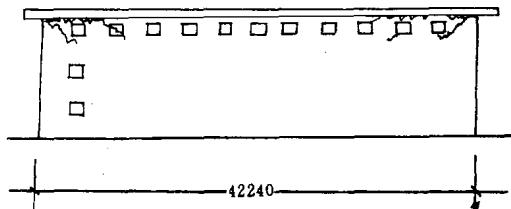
钢筋混凝土屋盖的收缩裂缝
